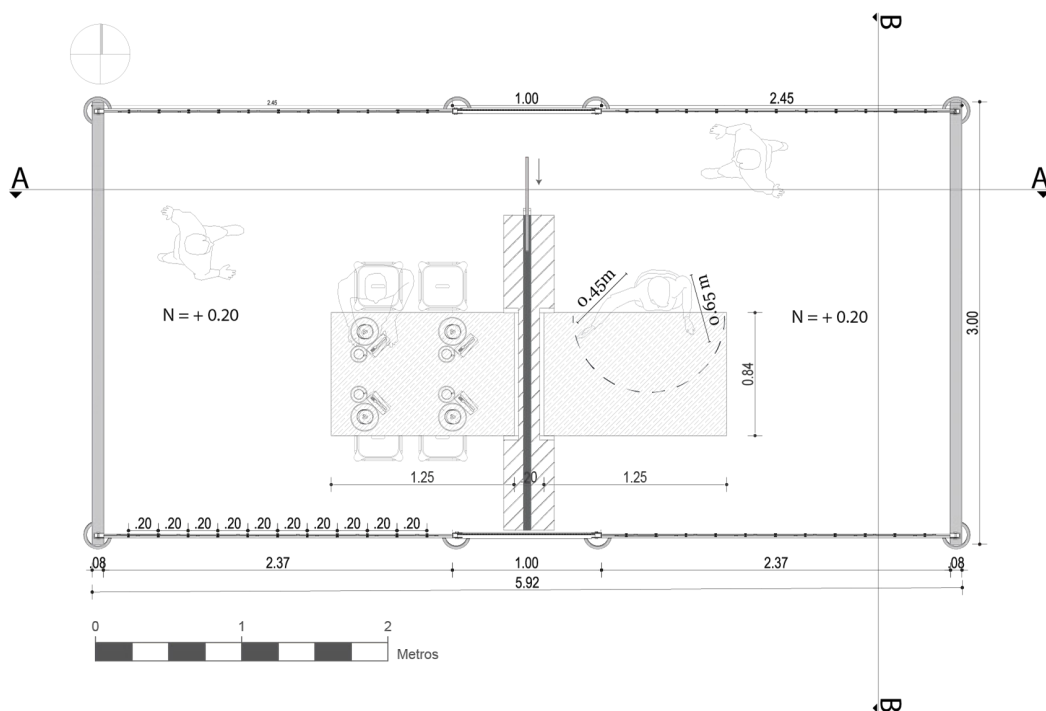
Ergonomía del Folding Shelter Housing zona de alimentación. Elaboración: Autores.
